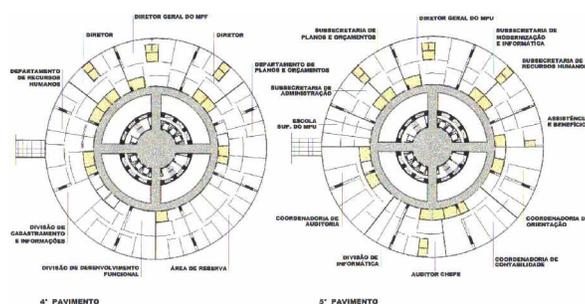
Planta Baixa do bloco B mostrando o 4º e o 5º pavimento. Fonte: Ana Elisa Niemeyer.
